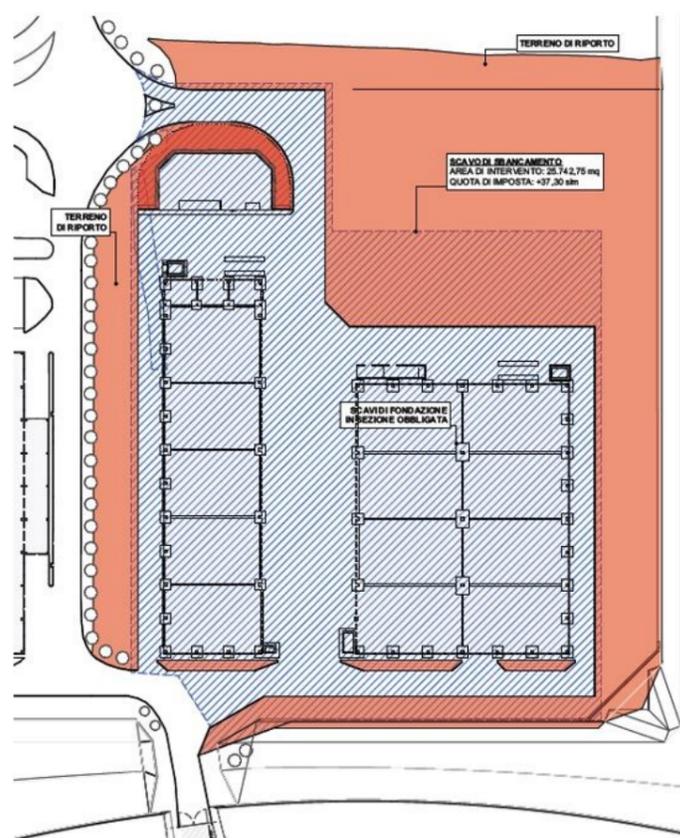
Planimetria Scavi e riporti di terreno. Sono previsti scavi di sbancamento fino a quota +37.30 m (retino azzurro), riporti di terreno (in arancio), e, in corrispondenza dei plinti di fondazione dei fabbricati A e B, scavi a sezione obbligatoria
